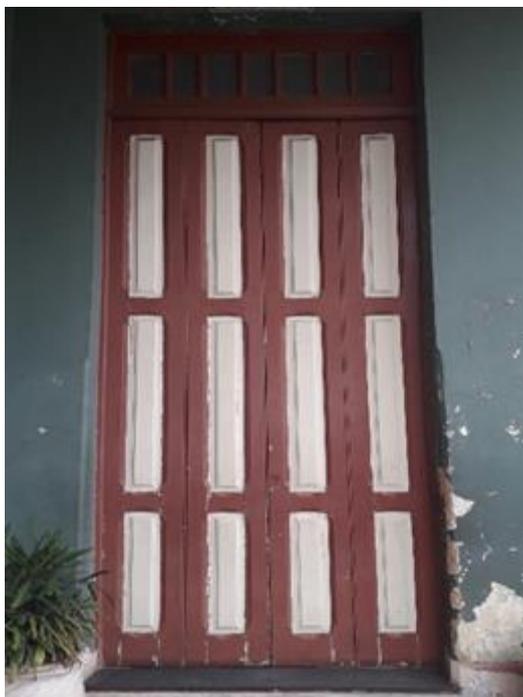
Porta da fachada Praça Melo Viana I (pavimento superior)
